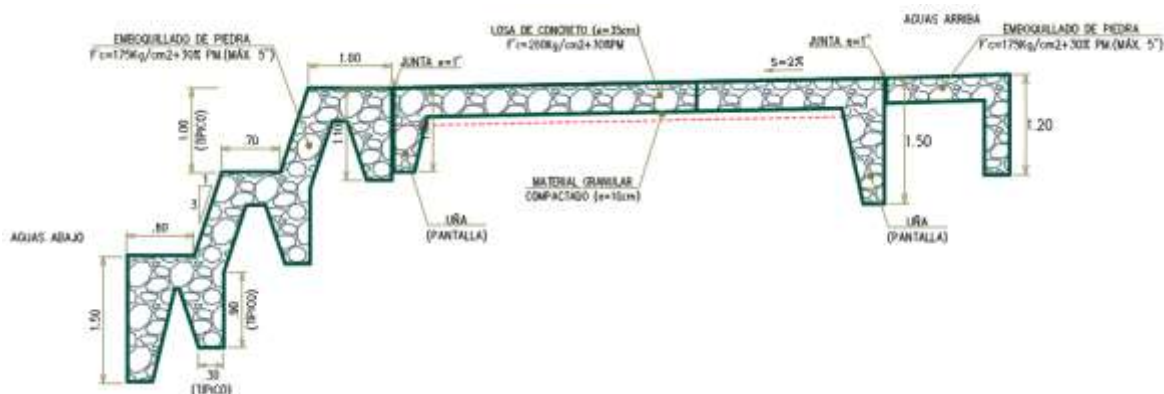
Sección de baden. Fuente: Planos de estructuras.
